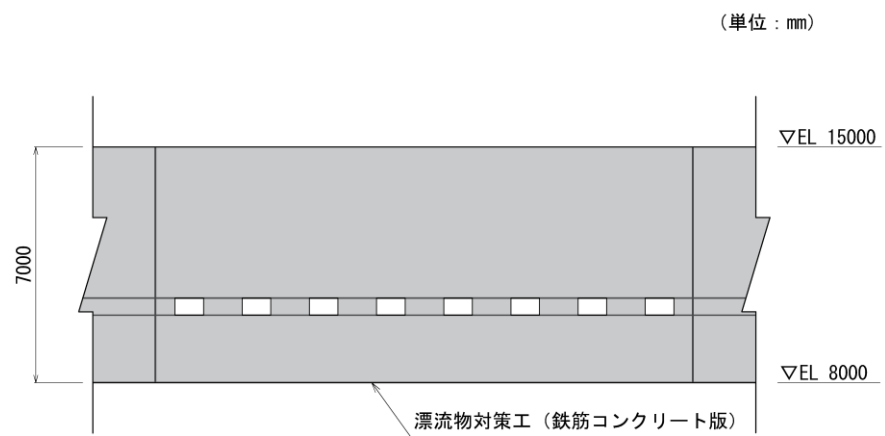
(2) 漂流物対策工 (鉄筋コンクリート版) の構造概要図 (正面図)
